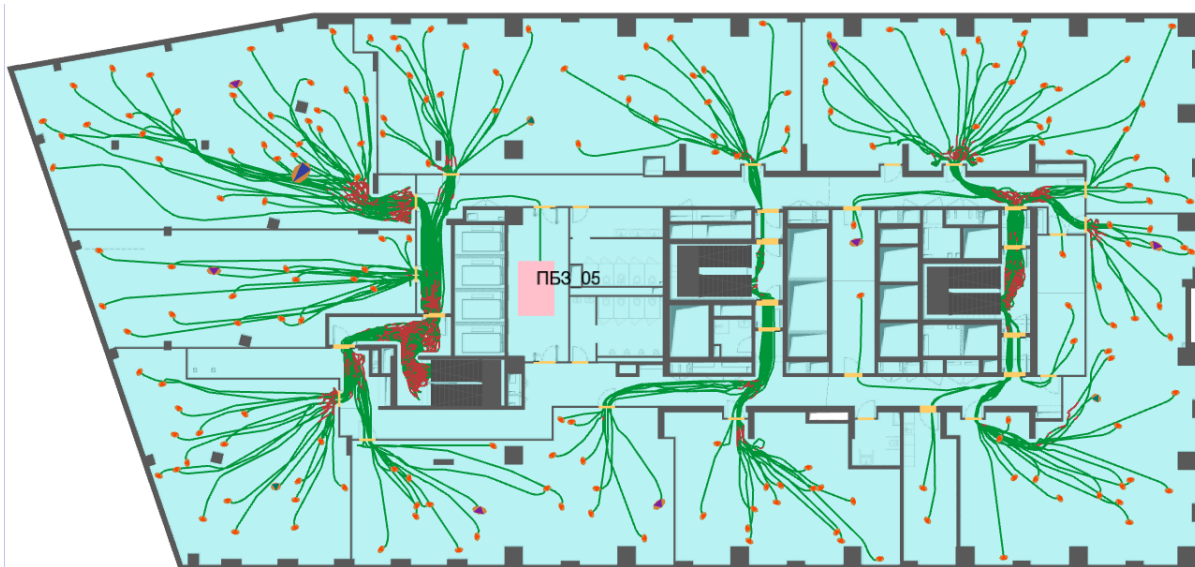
План 5-го этажа и нанесенная на него расчетная (принципиальная) схема эвакуации
